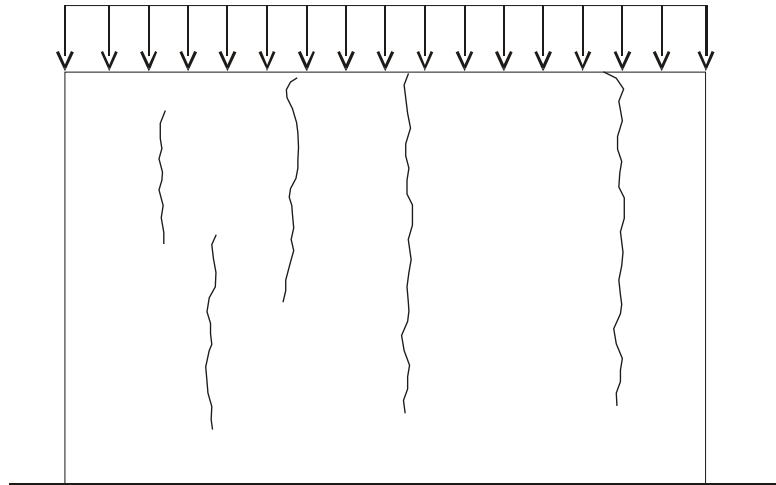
Fissuras verticais em paredes de alvenarias, devidas a atuação de carga vertical uniformemente distribuída
